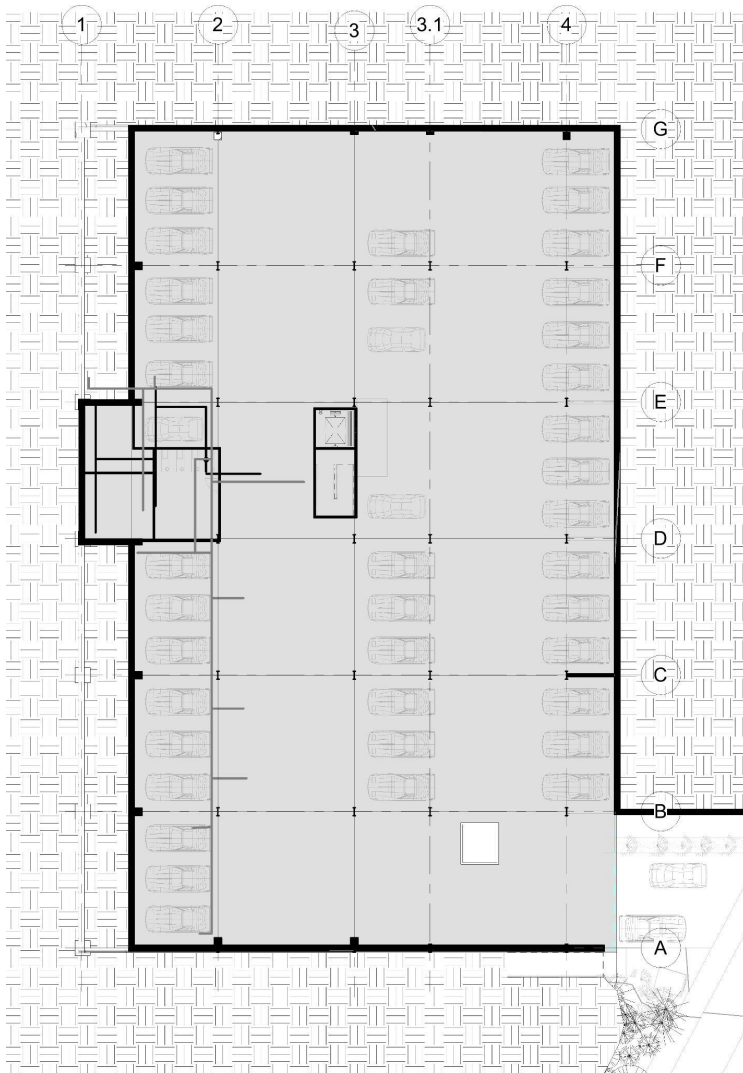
Planta de rutas mecánicas sótano. Fuente propia.
